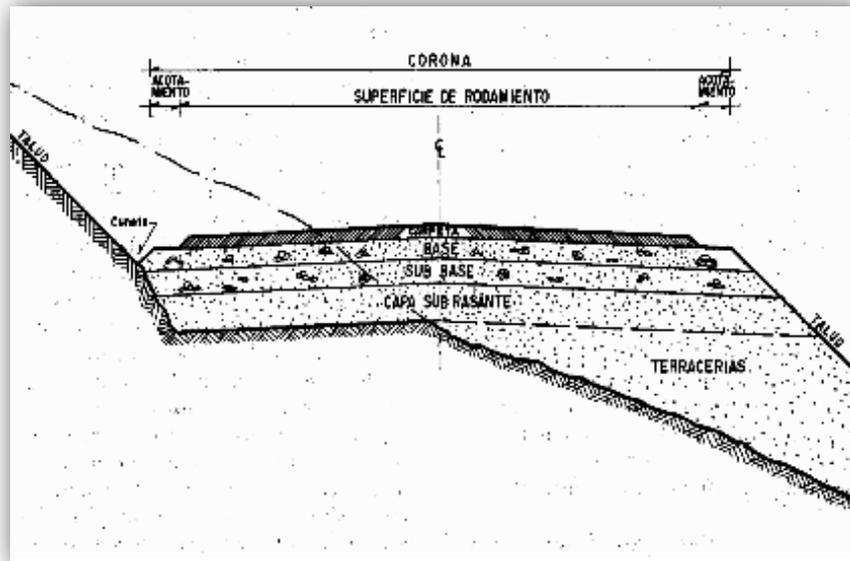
Sección transversal típica de un pavimento flexible (Rico y del Castillo, 1978).
